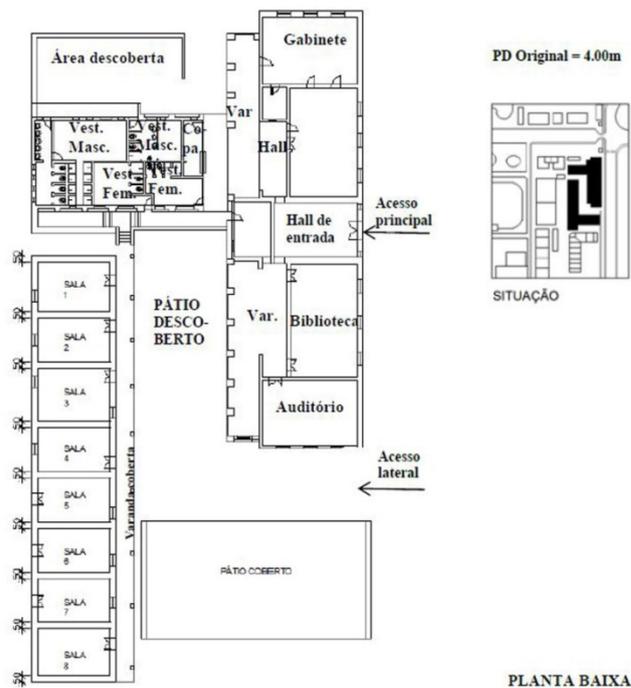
Planta baixa do conjunto da escola Antônio Prado Junior, anterior a ocupação da fundação RIOZOO.
